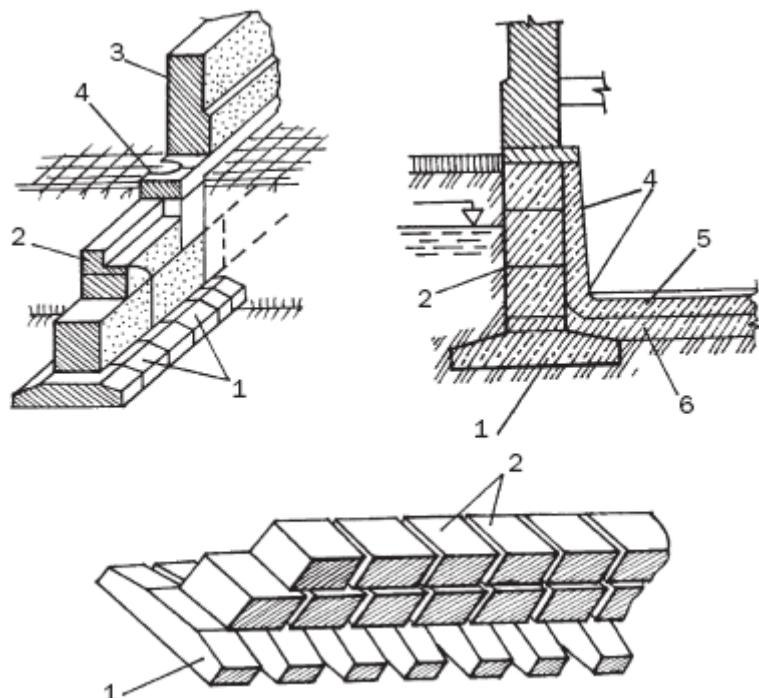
Расширение площади основания фундамента: 1 – железобетонная подушка; 2 – фундаментные блоки; 3 – цоколь; 4 – гидроизоляция; 5 – железобетонные плиты; 6 – бетонная подготовка
